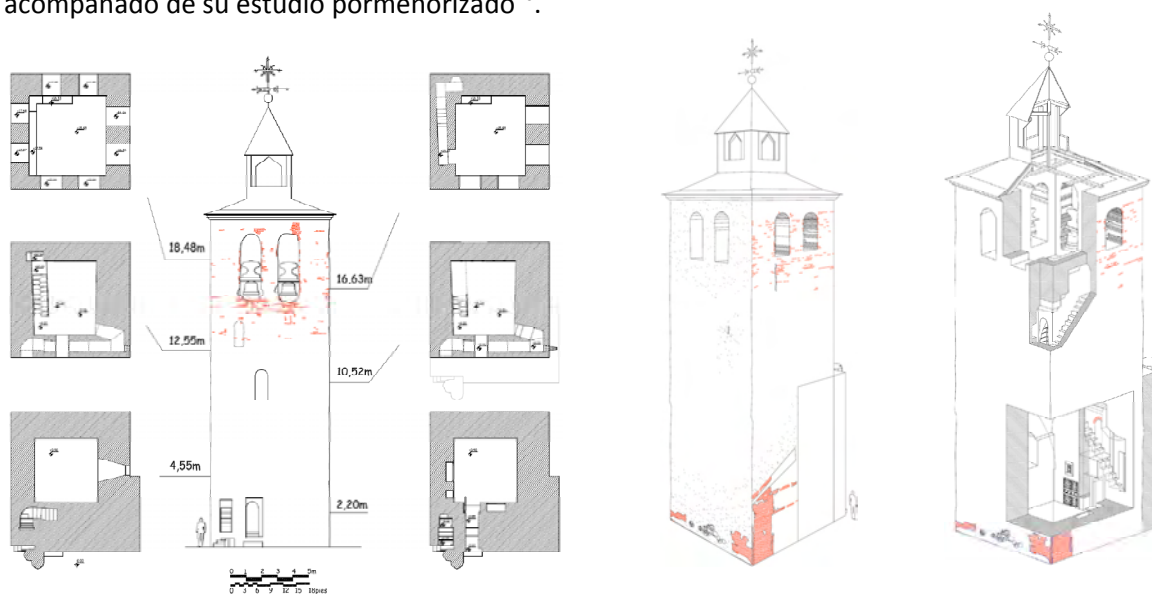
Plantas, alzado sur y axonometría desde el ángulo nordeste de la torre de Nuestra Señora de la Asunción en Adanero. Dibujo de Salvatore Barba. 2008.
